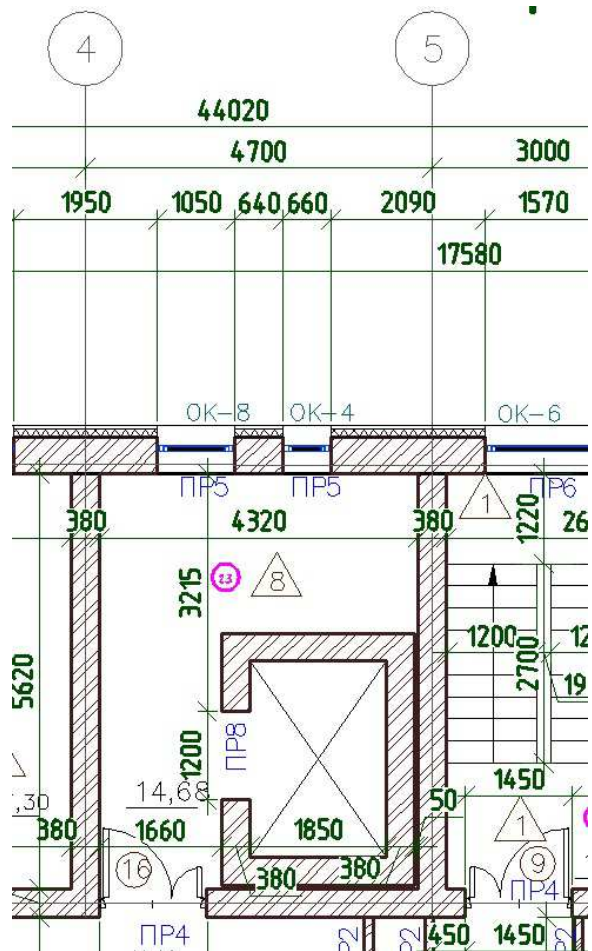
Рассматриваемый участок плиты перекрытия типового этажа
